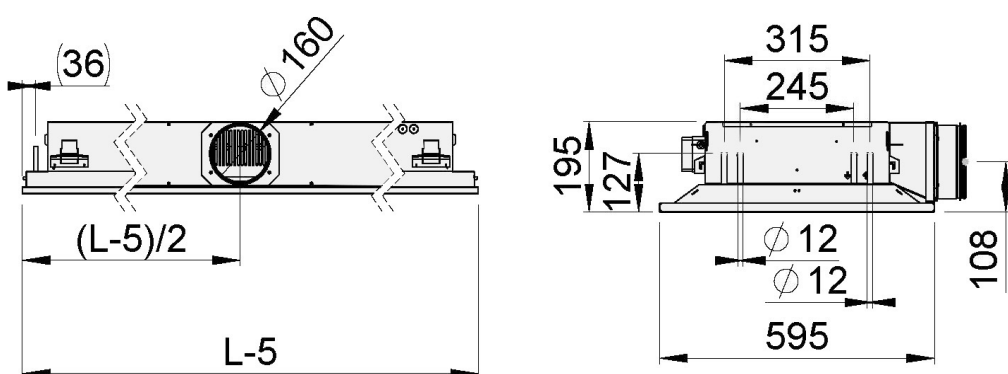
Dimensions de la Halton Rex R6W, batterie de chauffage (TC = H)
